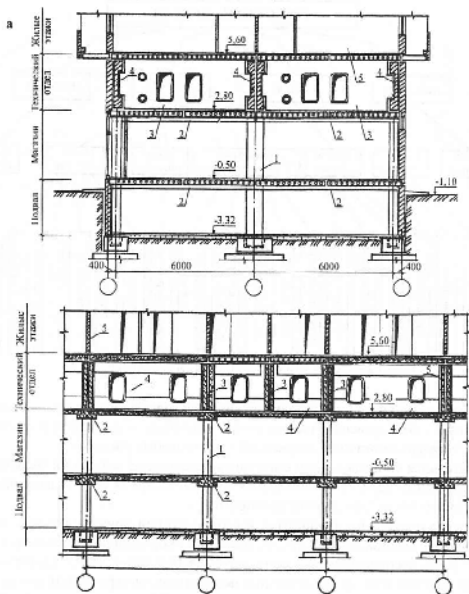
Пример комбинированной панельной и каркасной системы по высоте жилого дома с встроенным магазином: а – поперечный; б – продольный разрез: 1 – колонна; 2 – ригель каркаса нижнего яруса здания; 3,4 – несущие балки-стенки технического этажа; 5 – несущие стены жилых этажей
